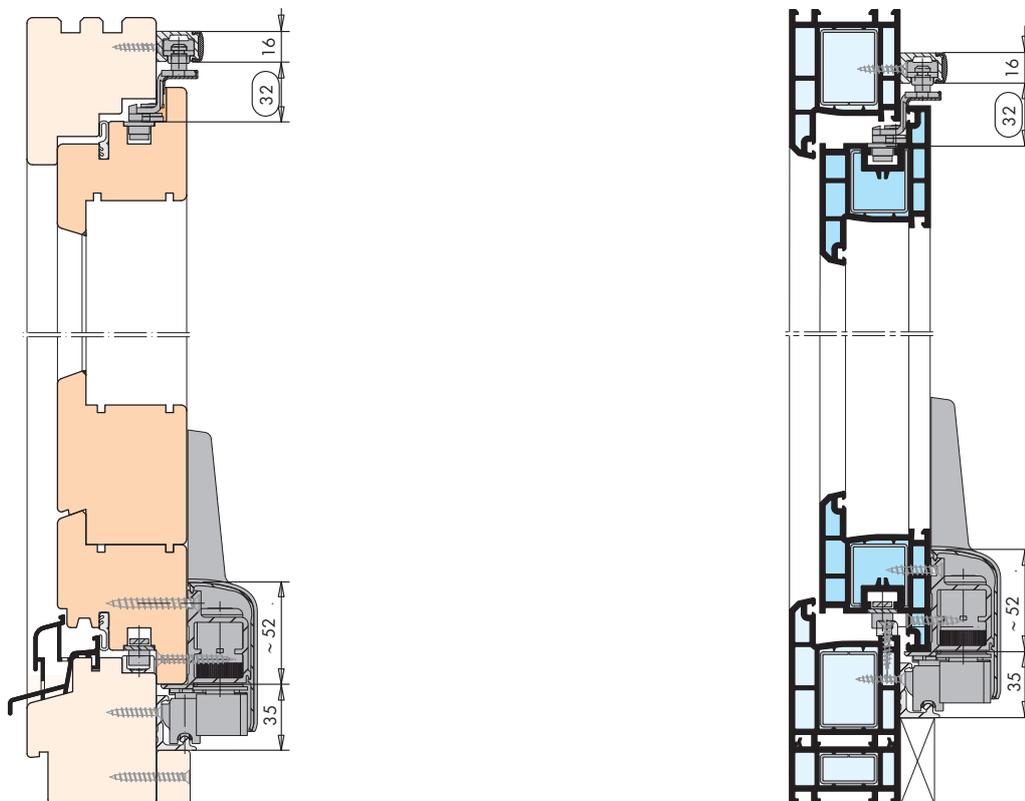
Vertikalschnitte Holz- und Kunststoff-Elemente
